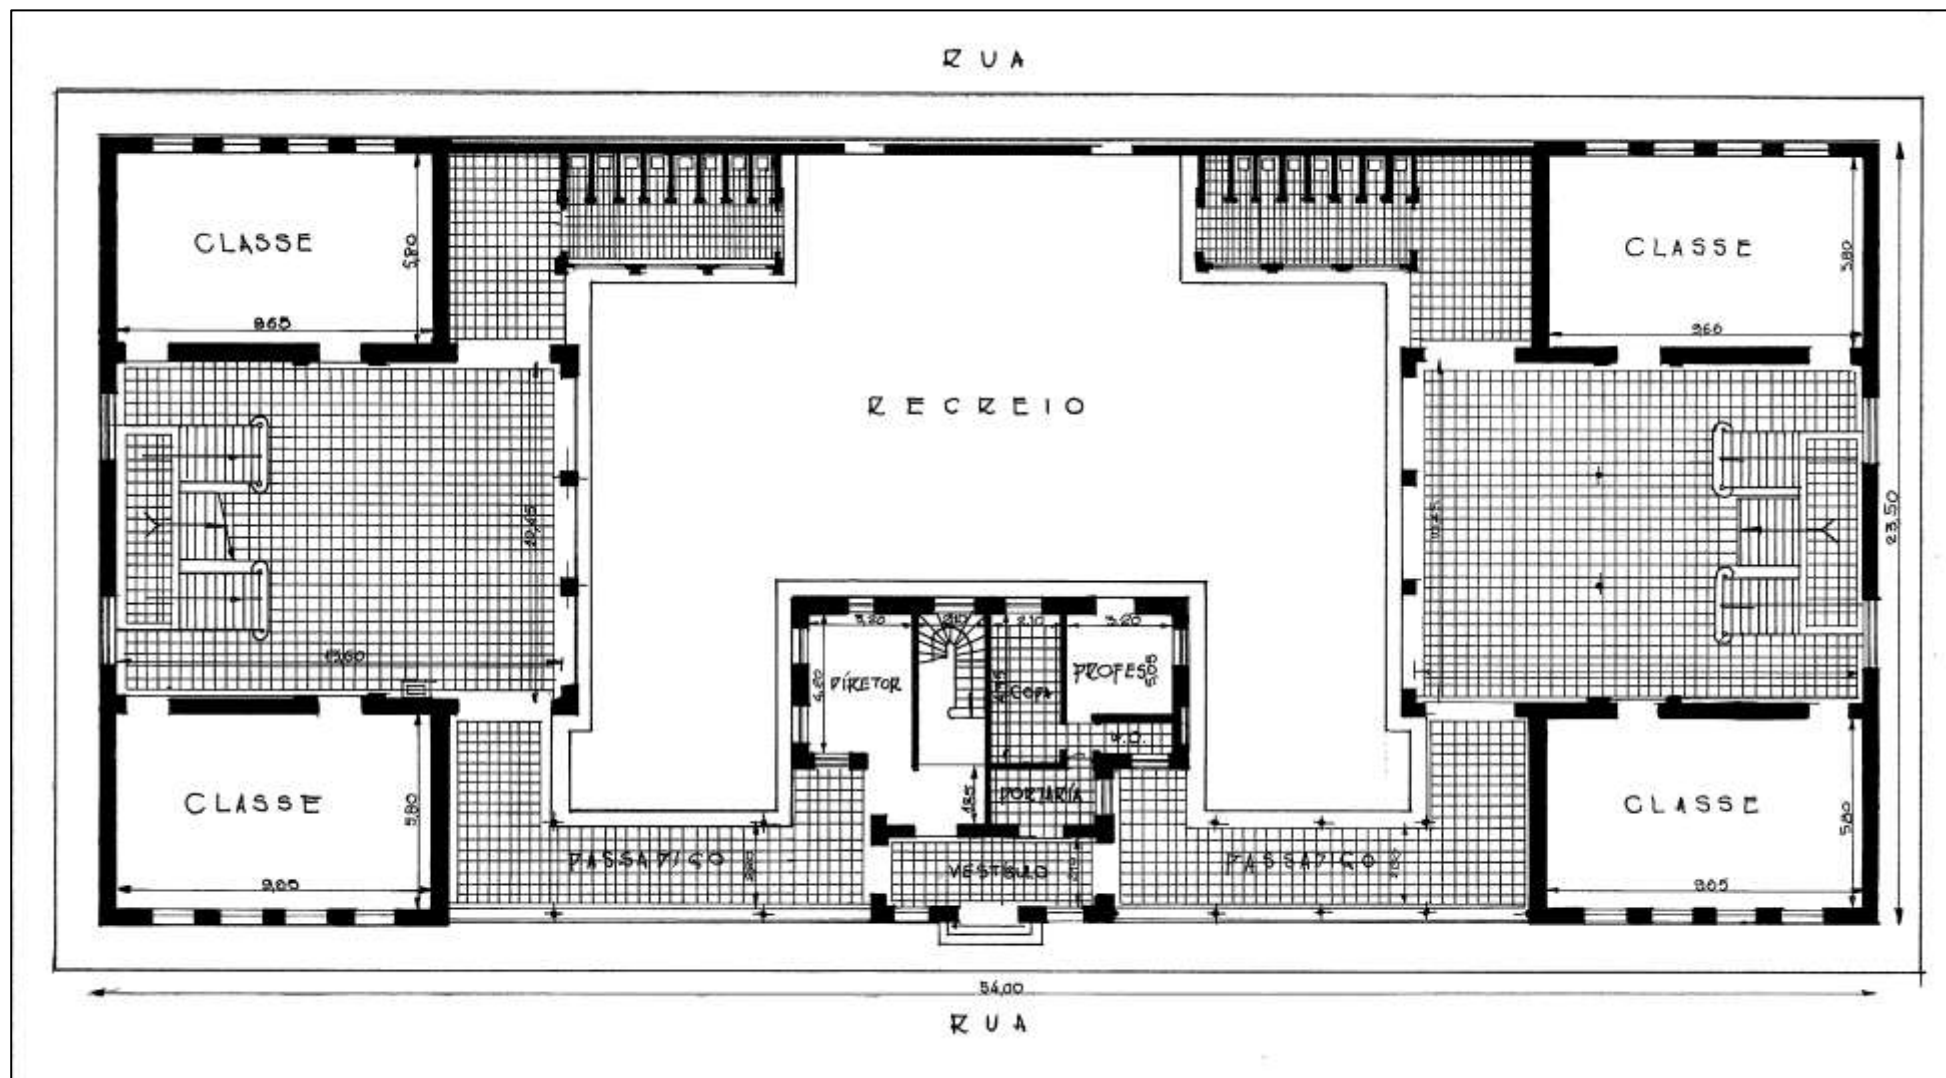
Estudo elaborado pelo autor sobre planta de 1912. Planta baixa do pavimento térreo dos edifícios Escola de Meninas e Escola de Meninos.
